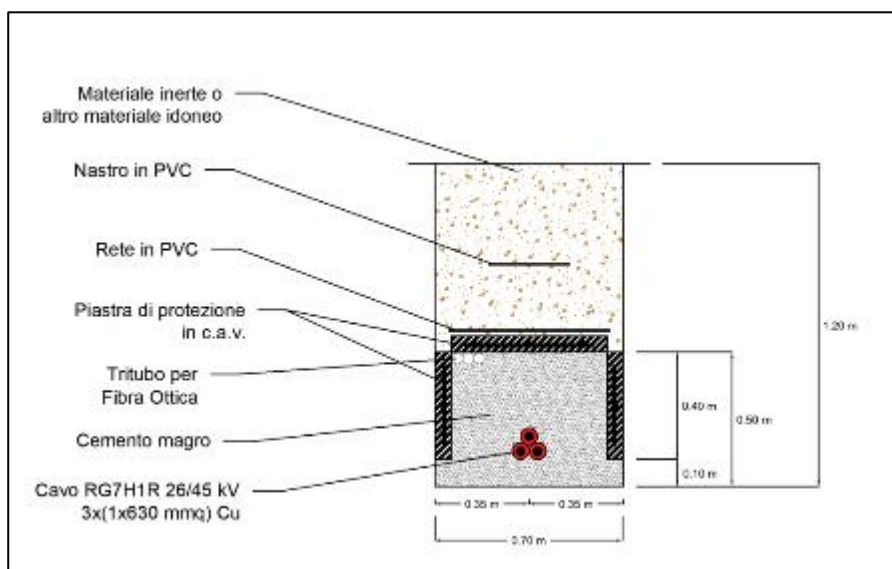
Tipico della sezione di scavo dell'ultimo tratto di cavidotto di connessione a 36 kV
